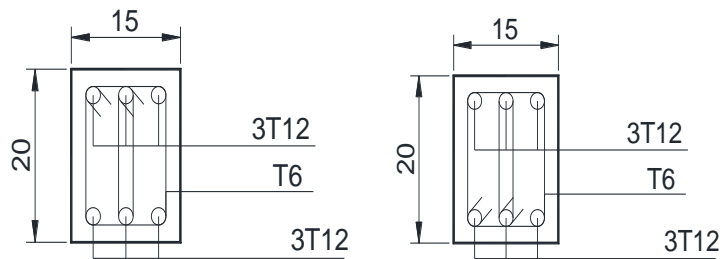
Coupe longitudinale d'une poutre noyée secondaire 15x20cm (plancher au dalles pleines)
